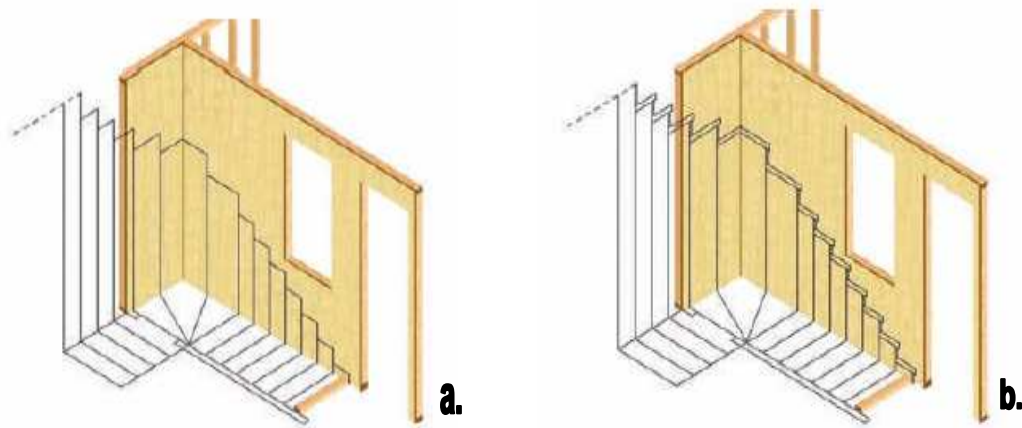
a. Trazado de la proyección horizontal y vertical de la escalera y ubicación de la pieza de anclaje (madera o conector metálico), para la fijación de apoyo de los largueros b. Trazado de la proyección horizontal y vertical de huellas y contrahuellas de la escalera
